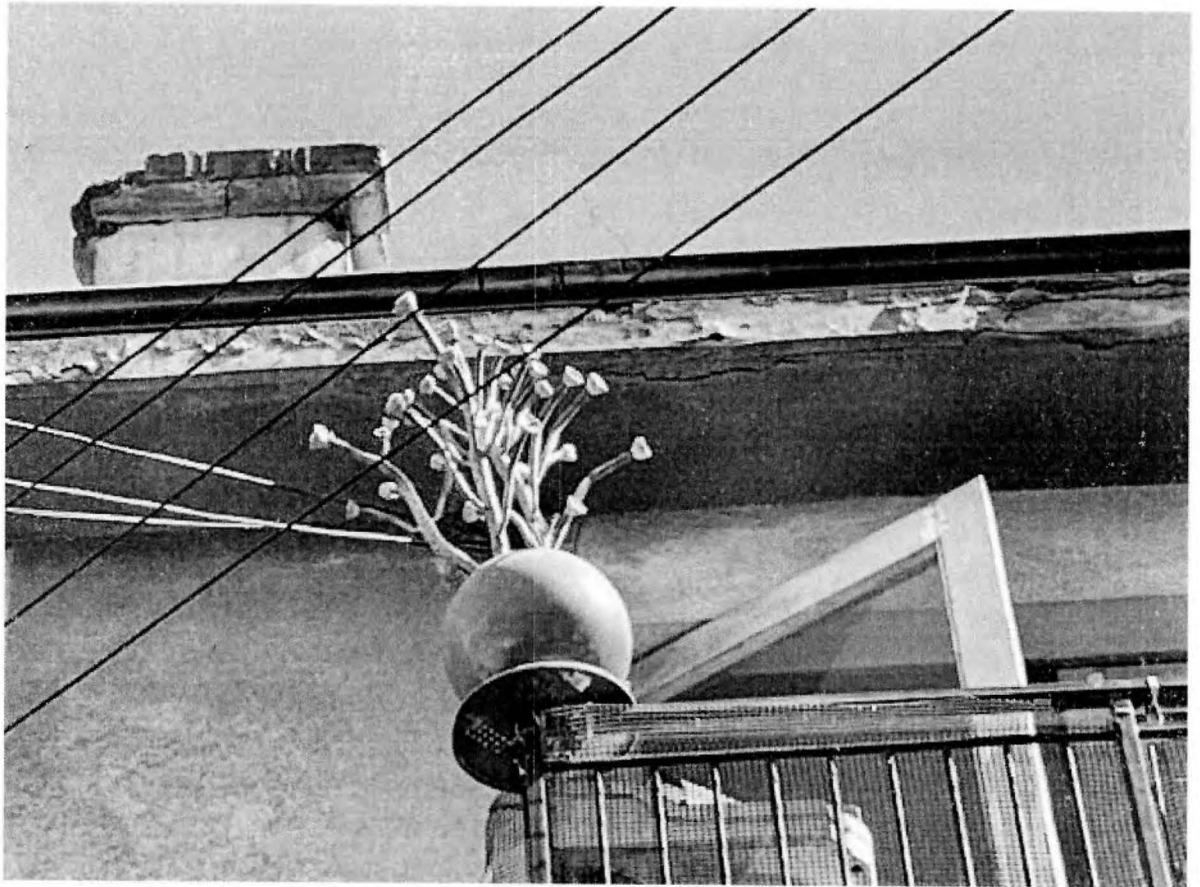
Daño por humedad y desprendimiento en alero de techo y salida de shaf en fachada sur.
